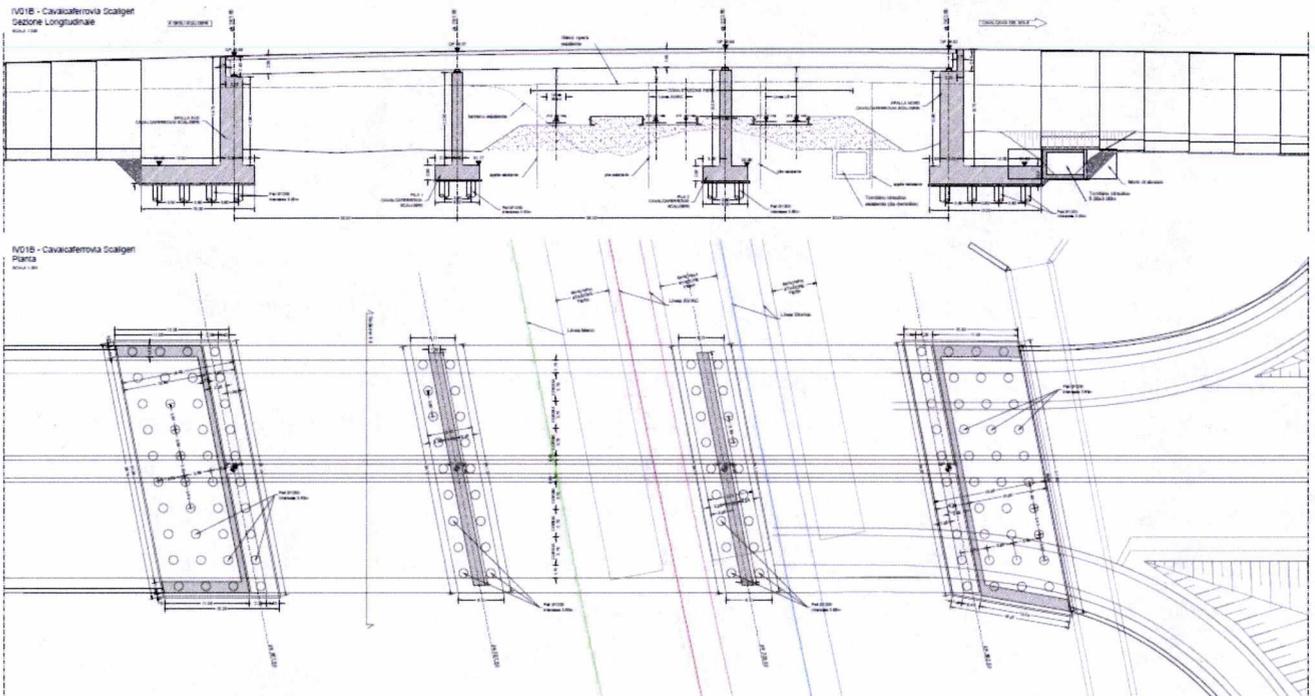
Planimetria e Profilo del Cavalcaferrovia Scaligeri
